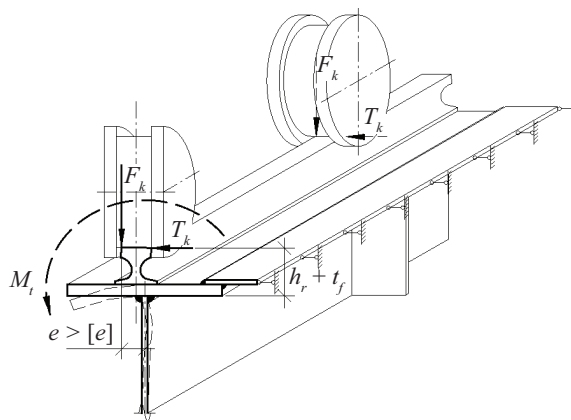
Действительная схема локальных нагрузок на подкрановую балку
